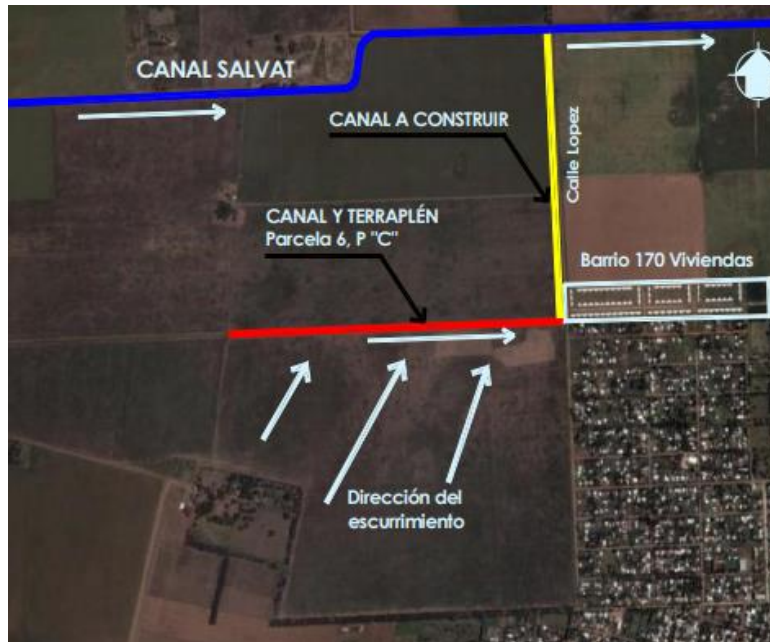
Croquis situación Funes Norte<sup>8</sup>
